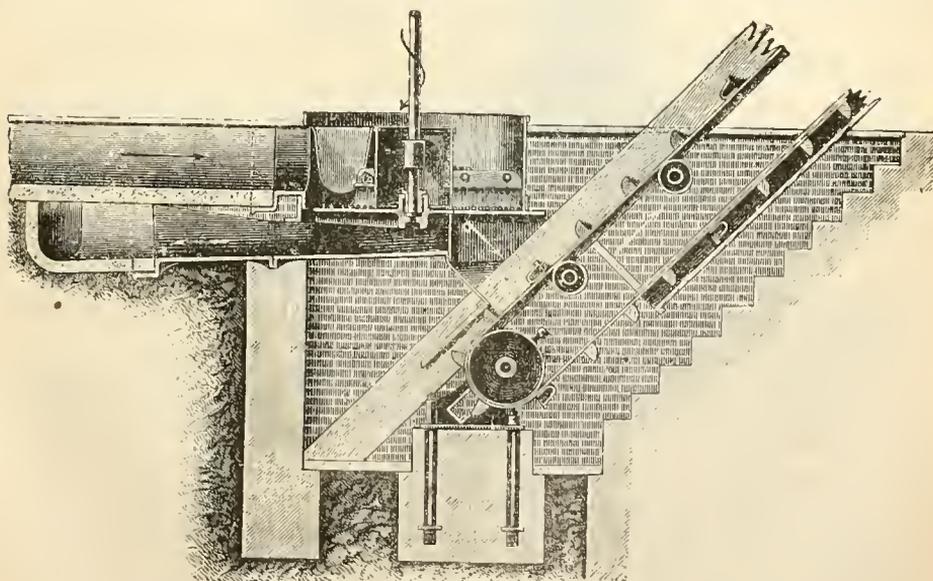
Coupe longitudinale du récepteur de betteraves.
